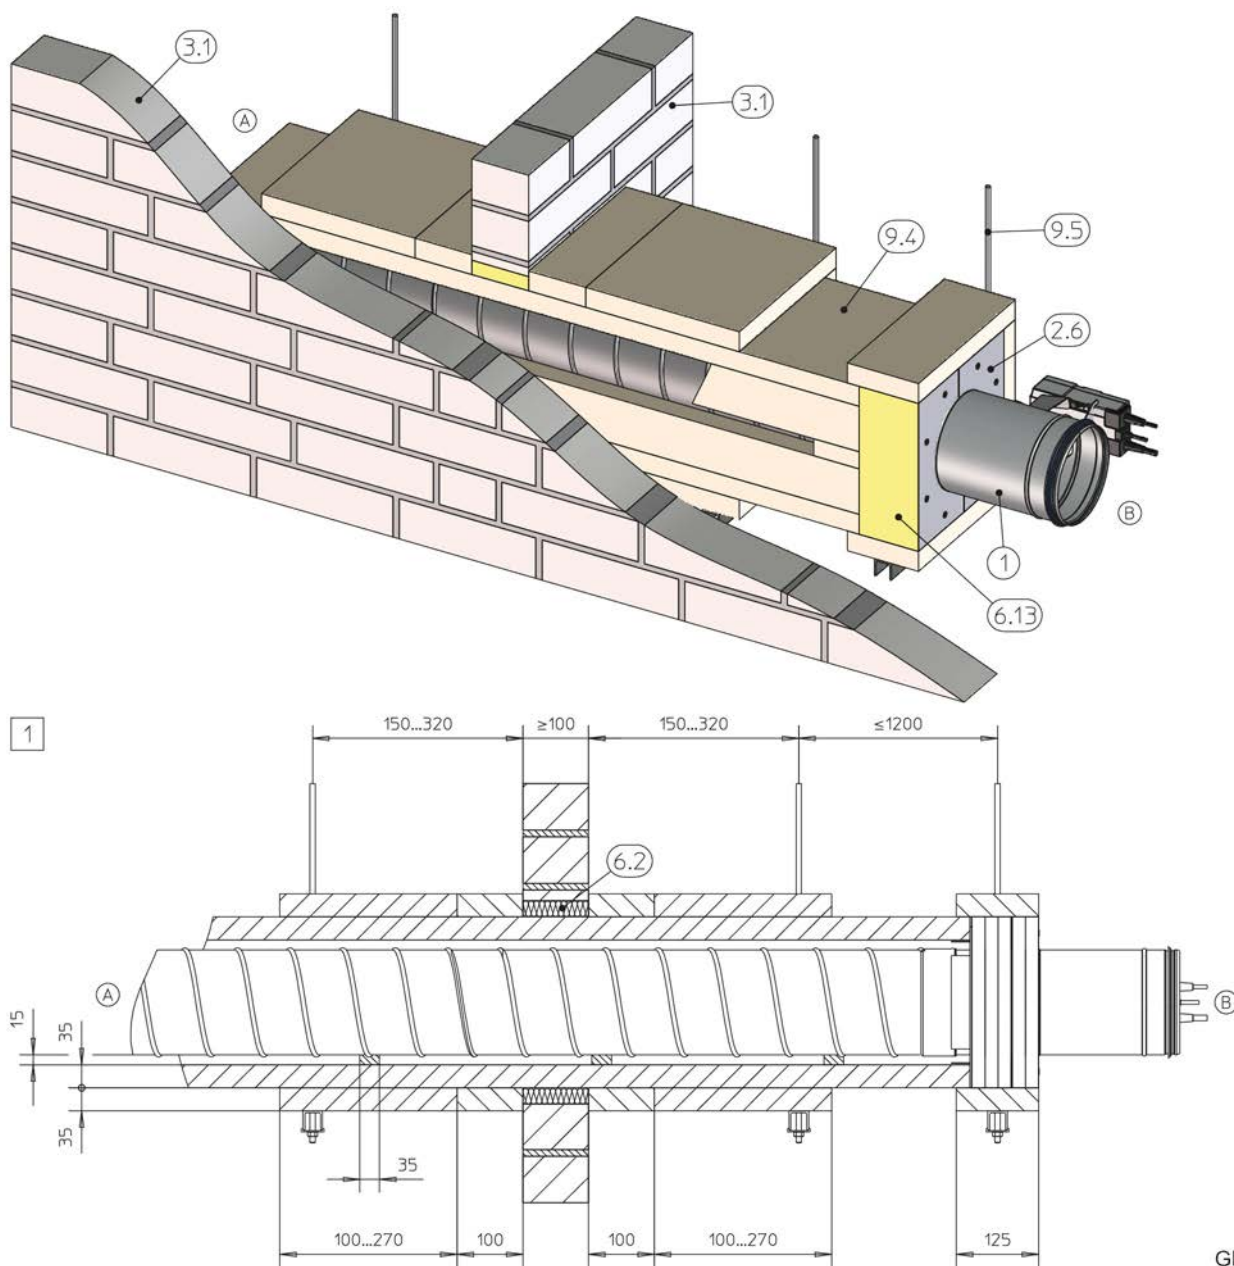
Монтаж без раствора на удалении от сплошной стены с проходом через стену, с облицовкой с трех сторон
